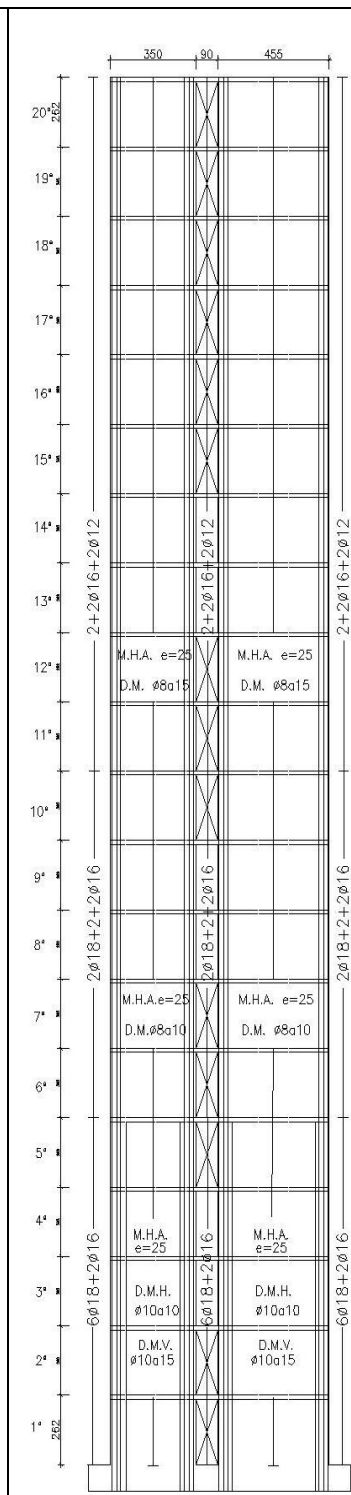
Elevación Eje Estructural 20 Pisos. Altura entre piso de 2.62 [m]. En los primeros 5 pisos existen estribos y trabas de confinamiento junto a malla
